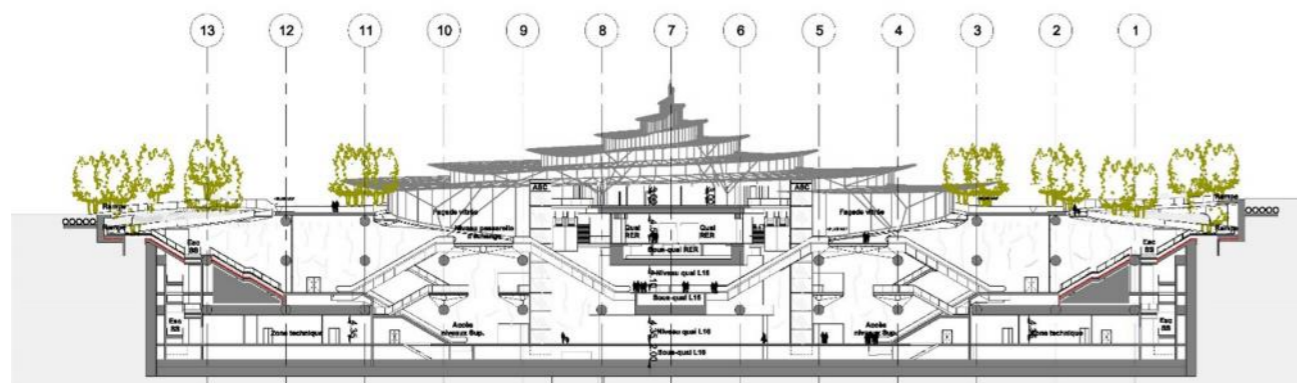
Coupe longitudinale de la gare – AD/AREP (01/12/2014)
